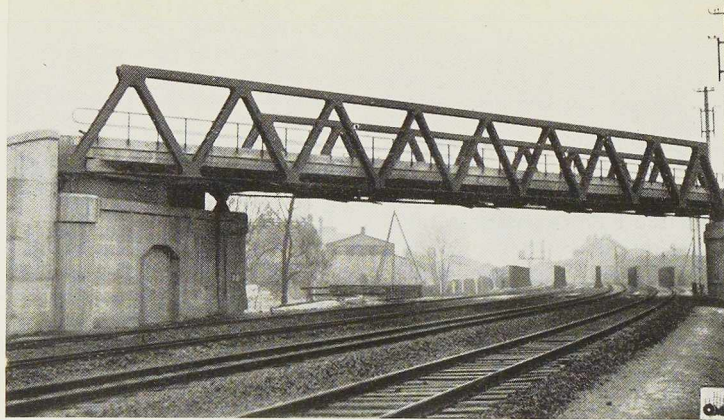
Vue du pont-rails soudé des Joncherolles (France).
